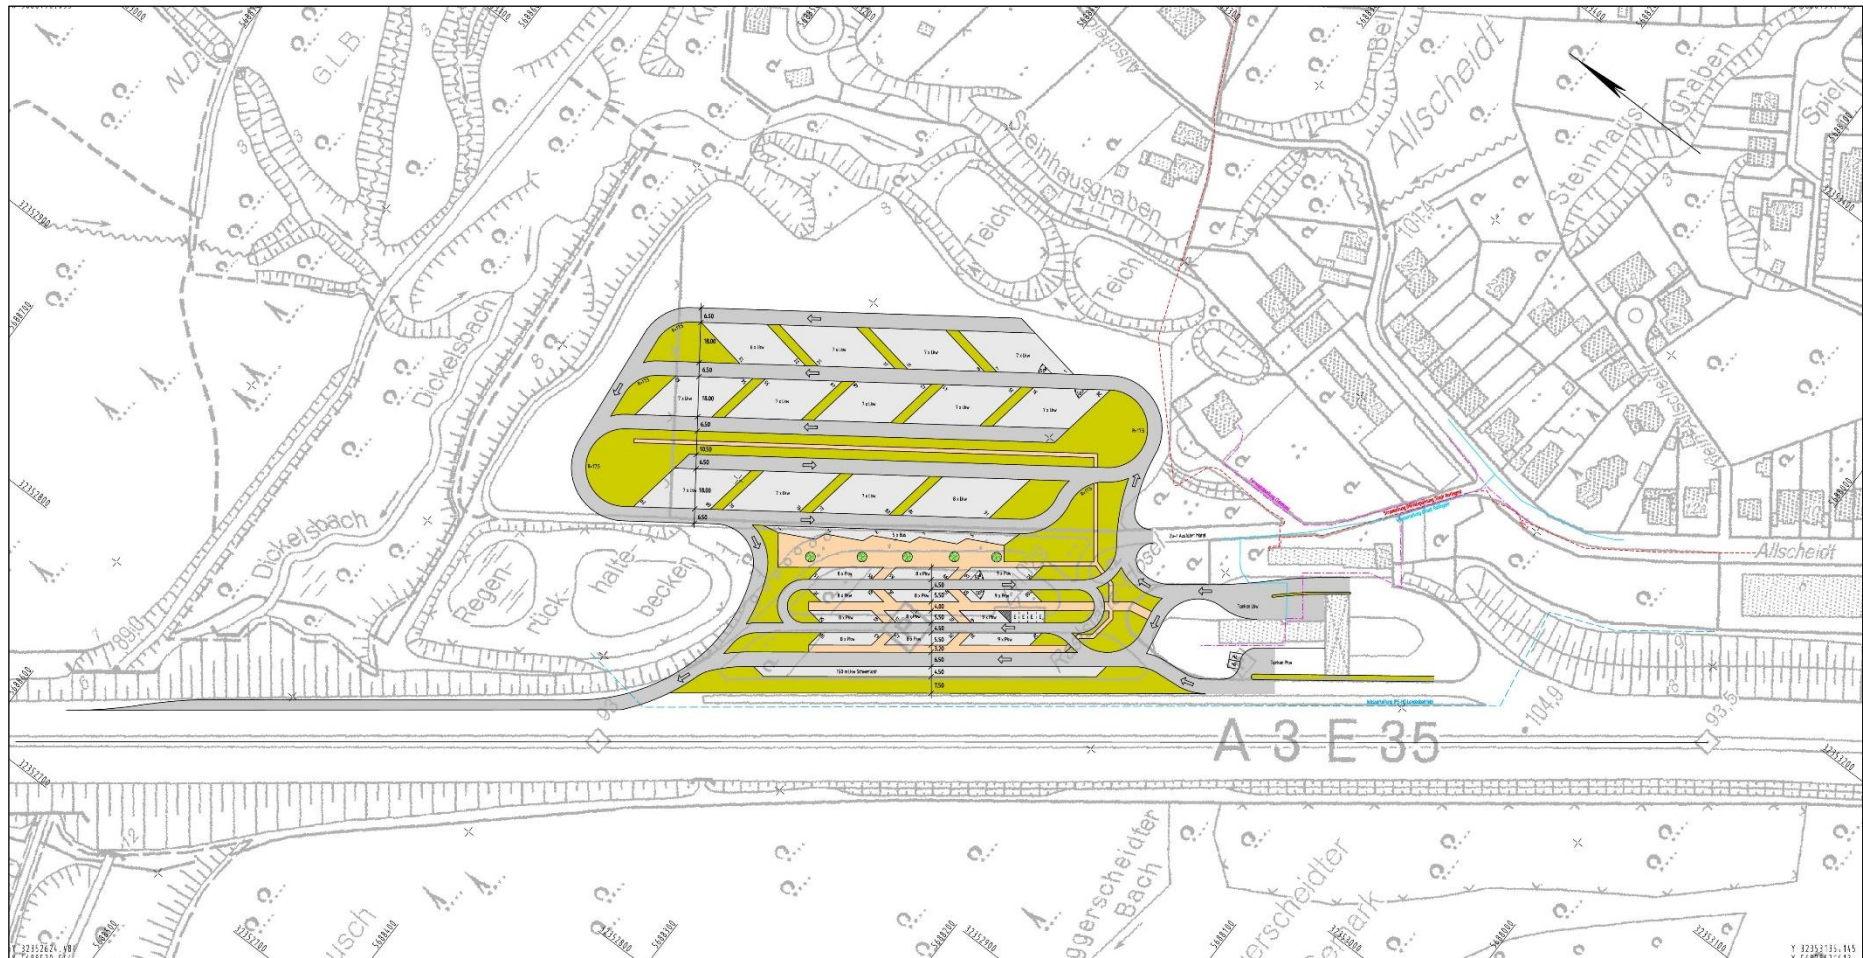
Lageplan der Variante 4 (Quelle: INGENAIX GMBH 2018)
